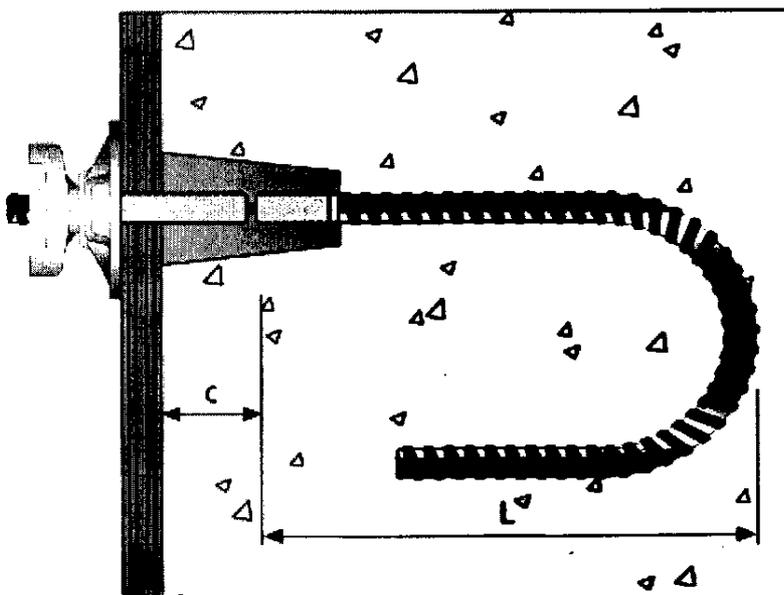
einbetonierter Schlaufenhaken aus Ankerstab
